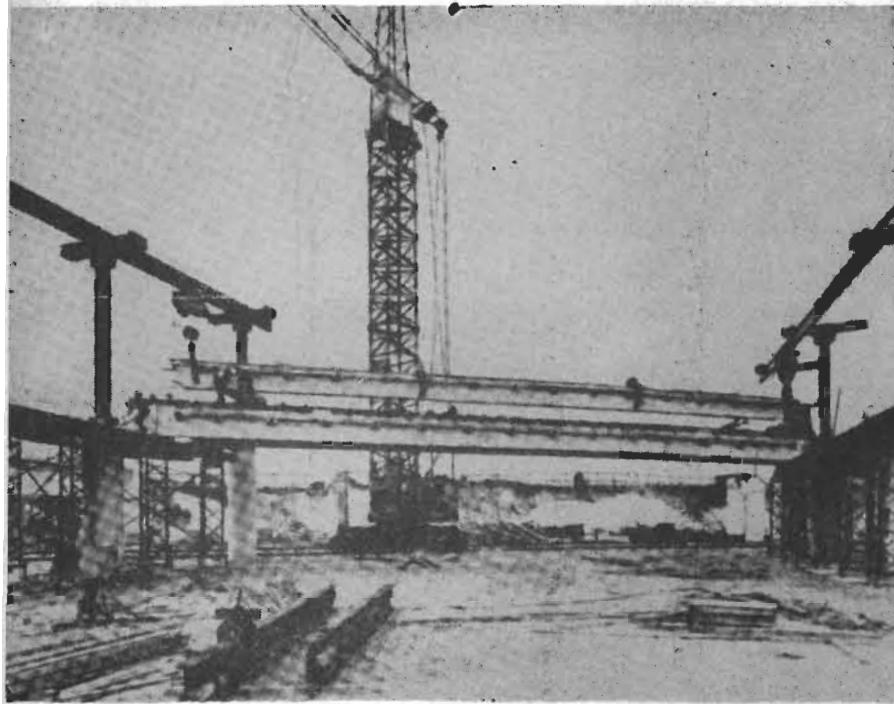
Montaje de las vigas prefabricadas en la intersección Schöneberg.
